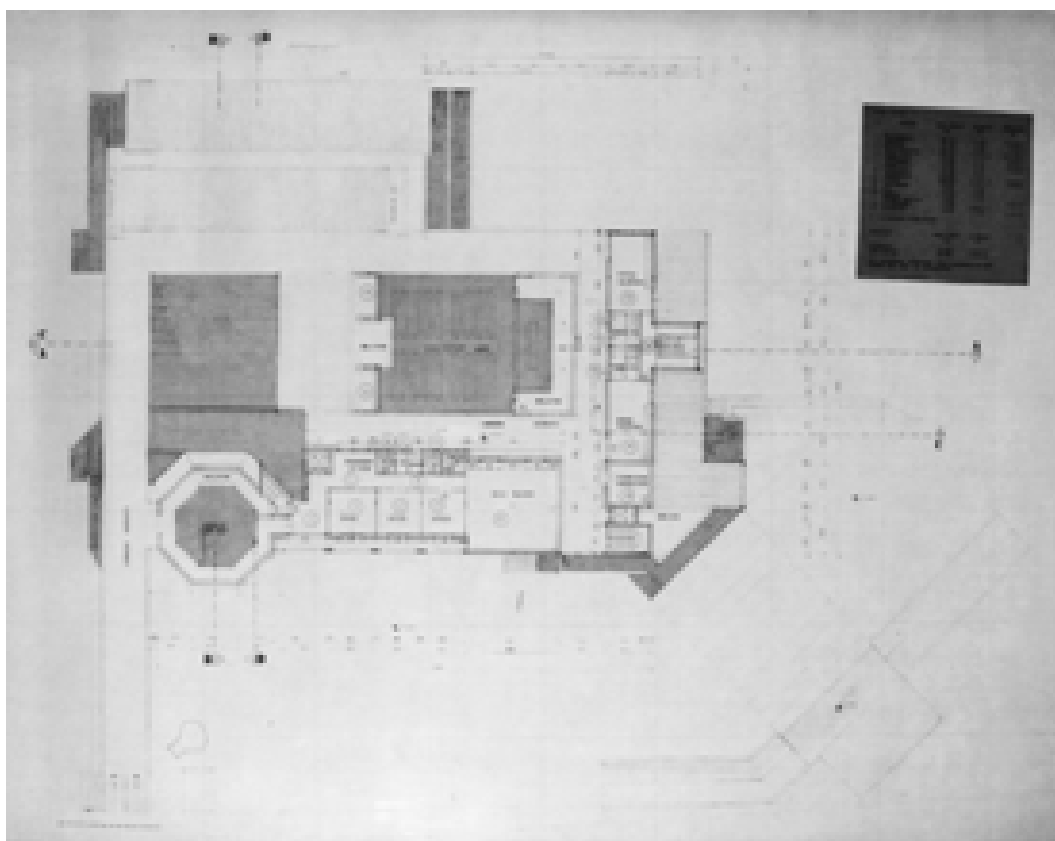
Pianta +4,00, stato futuro – 12/09/1991 (AABS-64_547)
